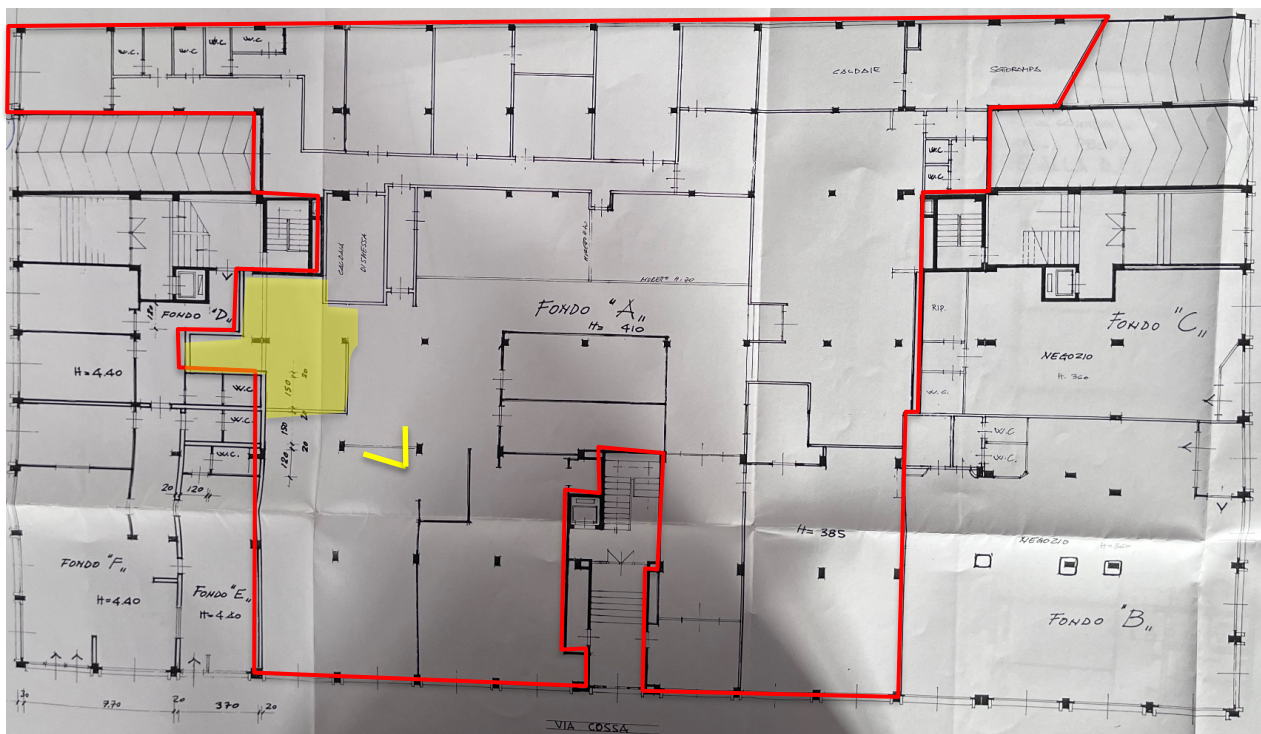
Elaborato di progetto allegato alla Variante della D.I.A. n. 12961/2005 – individuazione del fondo commerciale oggetto di stima
